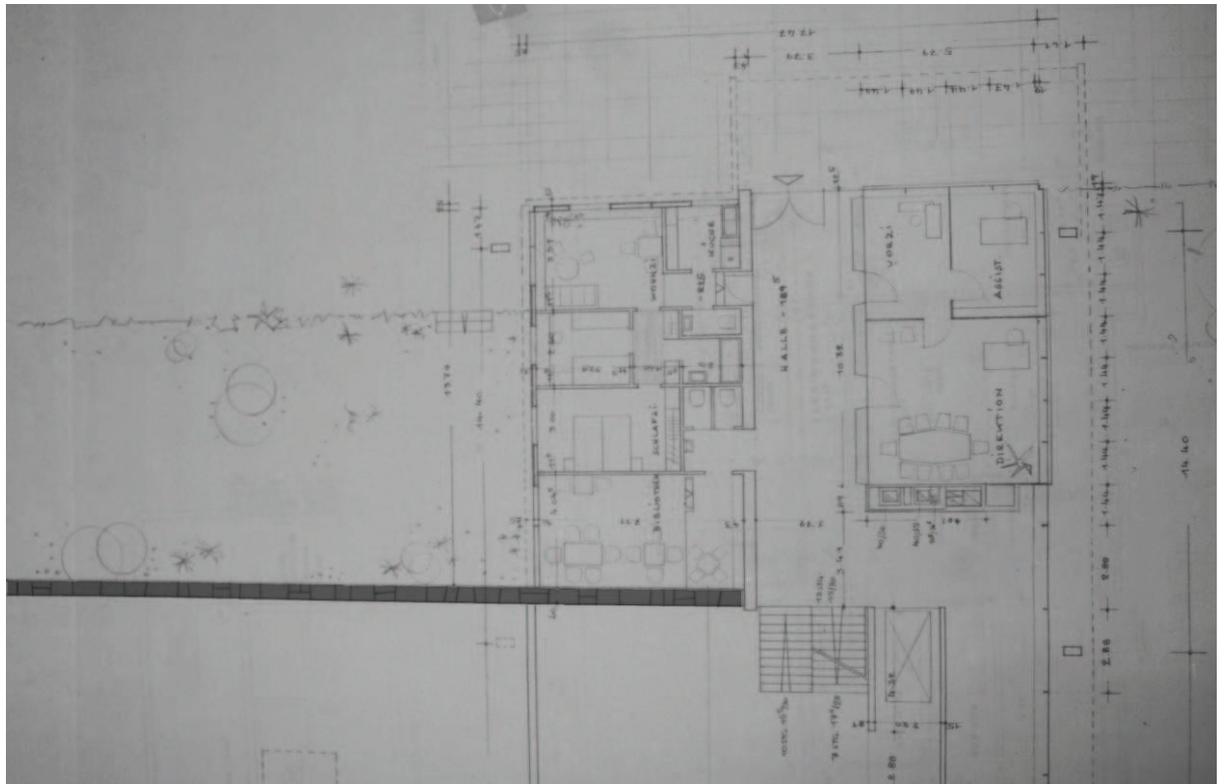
Manfred Lehbruck, Wilhelm Lehbruck Museum Duisburg, 1959-64, Grundriss des 1. UG der Glashalle, Maßstab 1:100 vom 15.1.1959, hier Detail des ehemaligen Bibliotheksimmers mit einer sich im Außenraum fortsetzenden Kieselmauer (StADu 72/ 71, Plan 283, Detail, bearbeitet)
